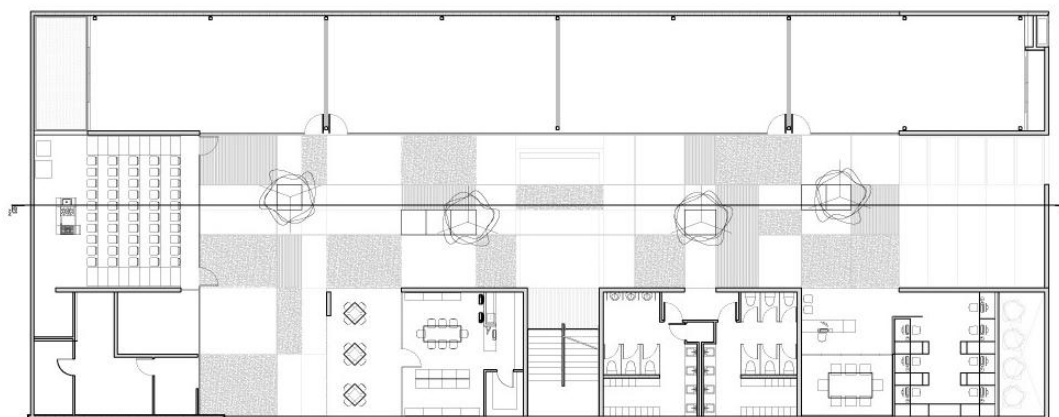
Planta baixa do primeiro pavimento mostrando os dois blocos e a praça central. Fonte: <http://www.archdaily.com/100778/culinary-art-school-gracia-studio>
